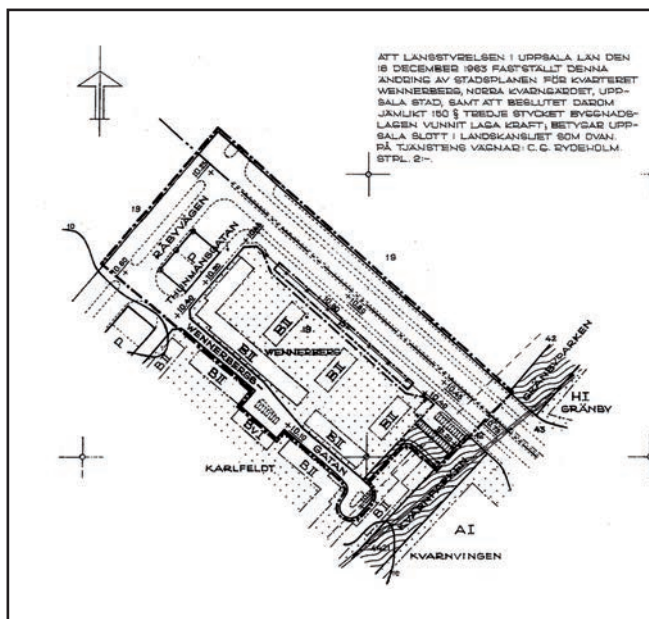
Planändring över delen närmast Tycho Hedens väg upprättad 1963. Huset ligger enligt denna plan 33 meter från vägmitt.
